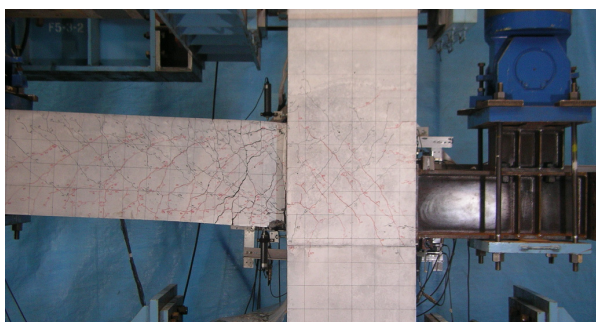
(a) No. 1 試験体破壊状況 ($Rrc=-1/33rad$.)
